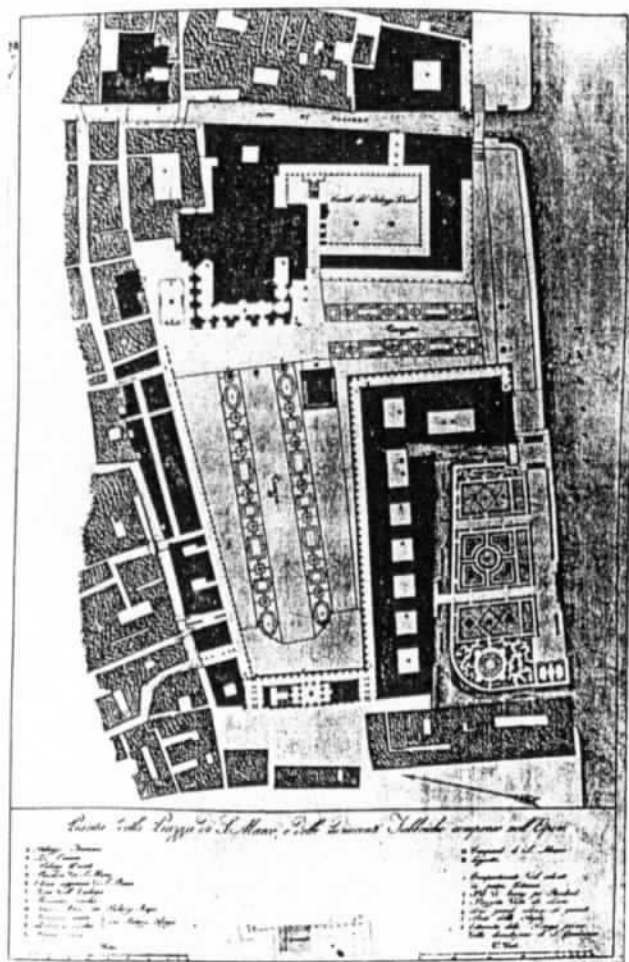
A. Mezzani, Planimetria di Piazza San Marco.
